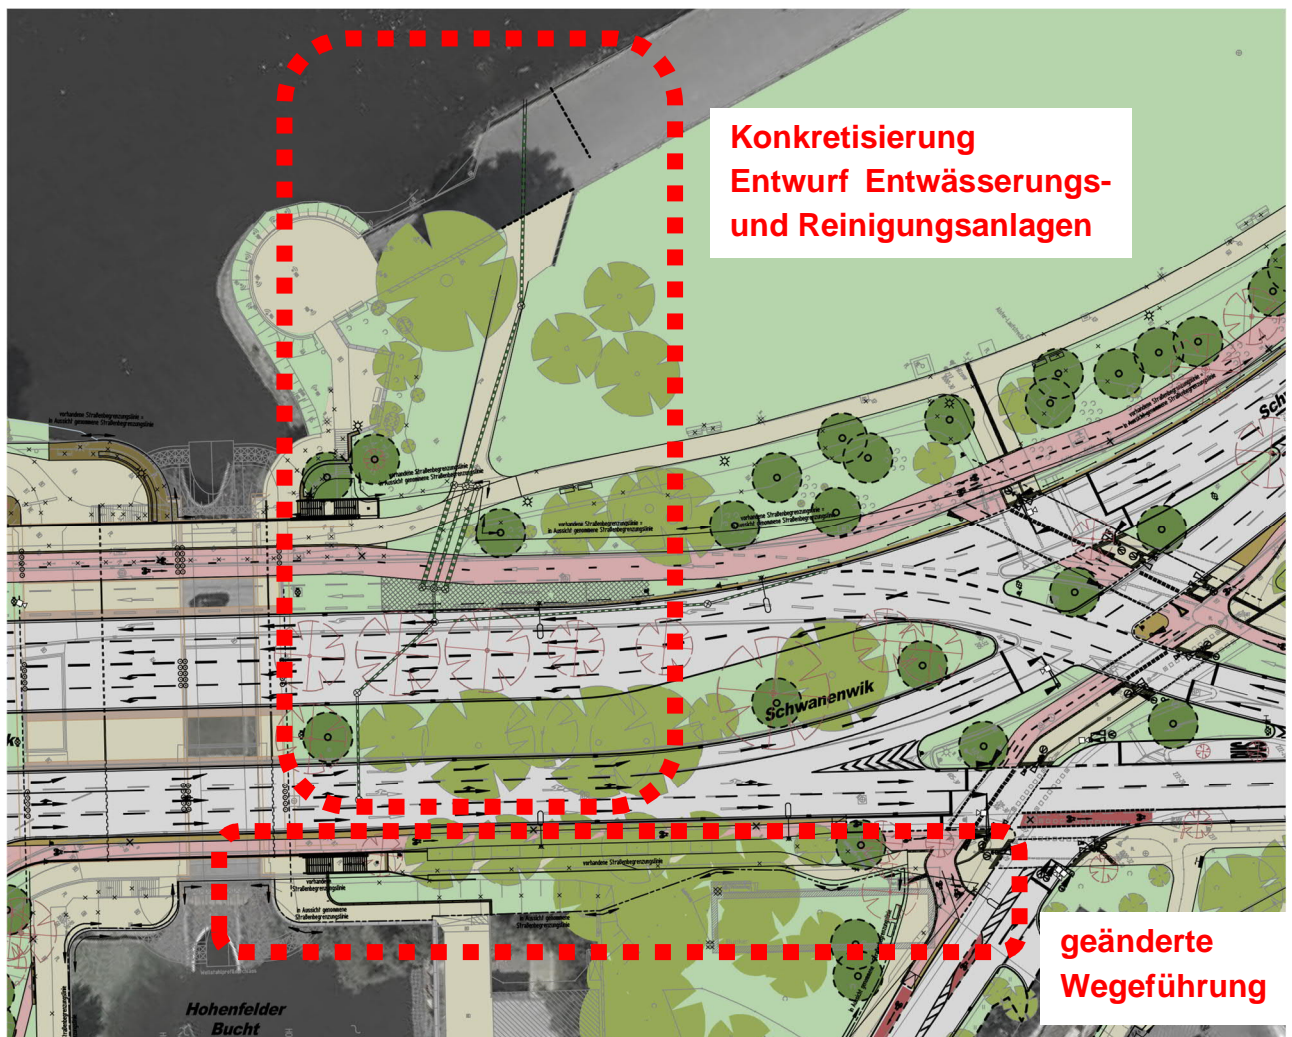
Lageplan-Ausschnitt mit Schwanenwik zwischen Hohenfelder Brücke und Buchtstraße
